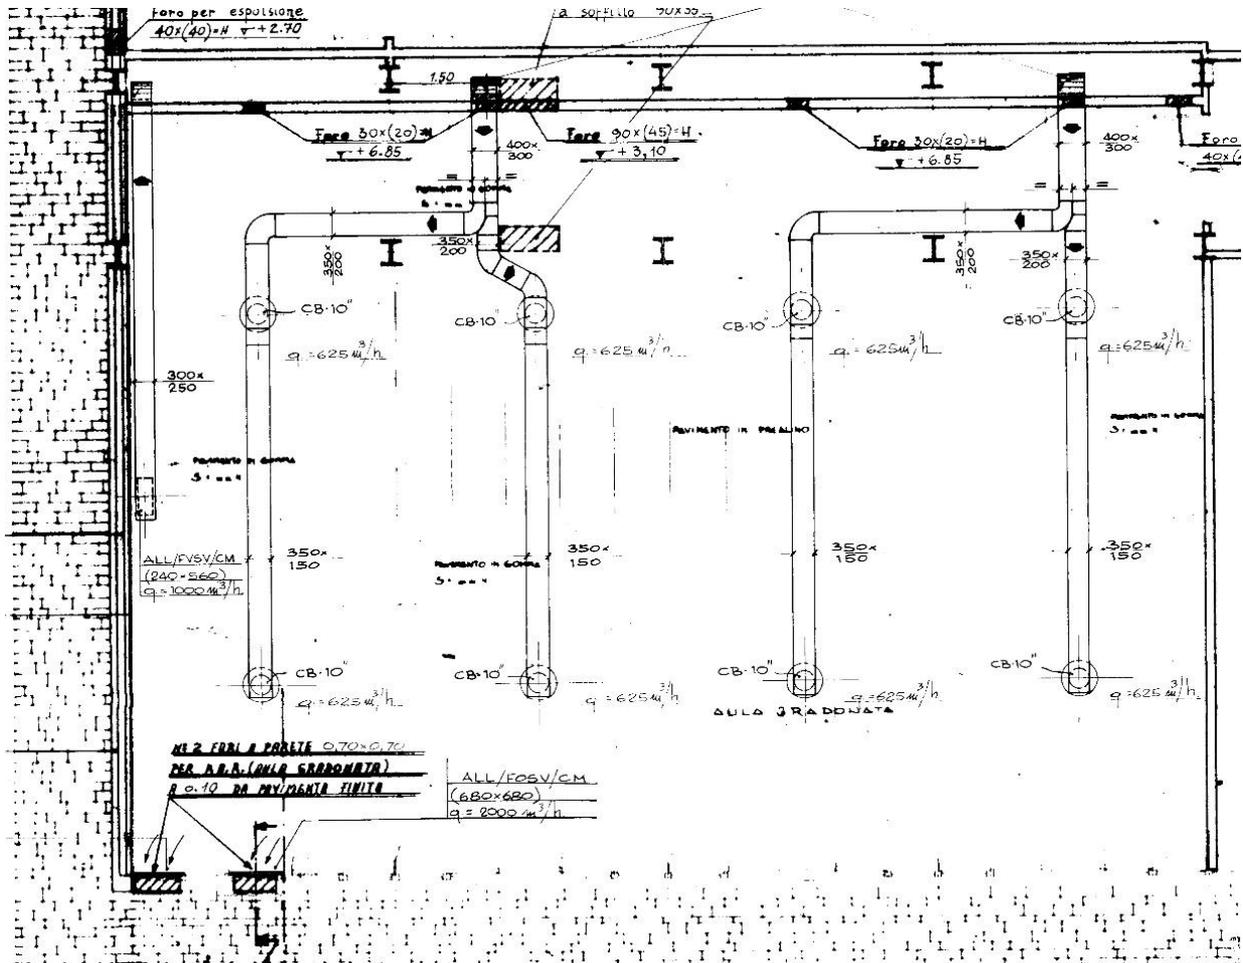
Impianto di Termoventilazione Aula "E" al piano terra Ala Est dell' edificio. La Uta è posizionata al piano interrato lato est.
